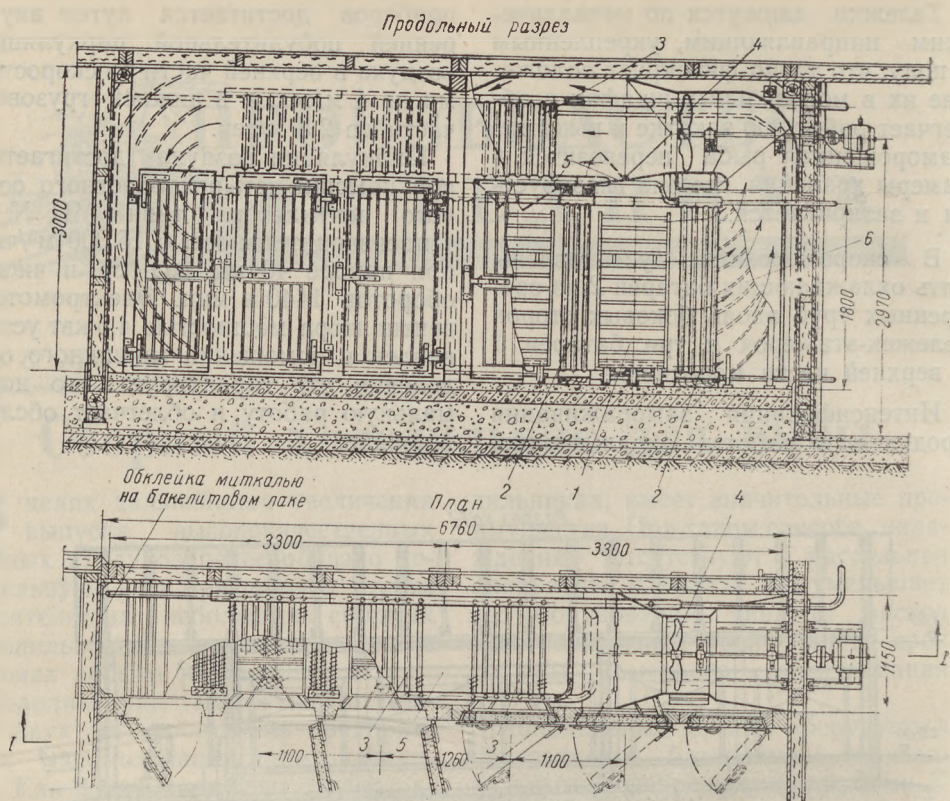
Продольный разрез и план скороморозилки конструкции Ю. Крылова.
